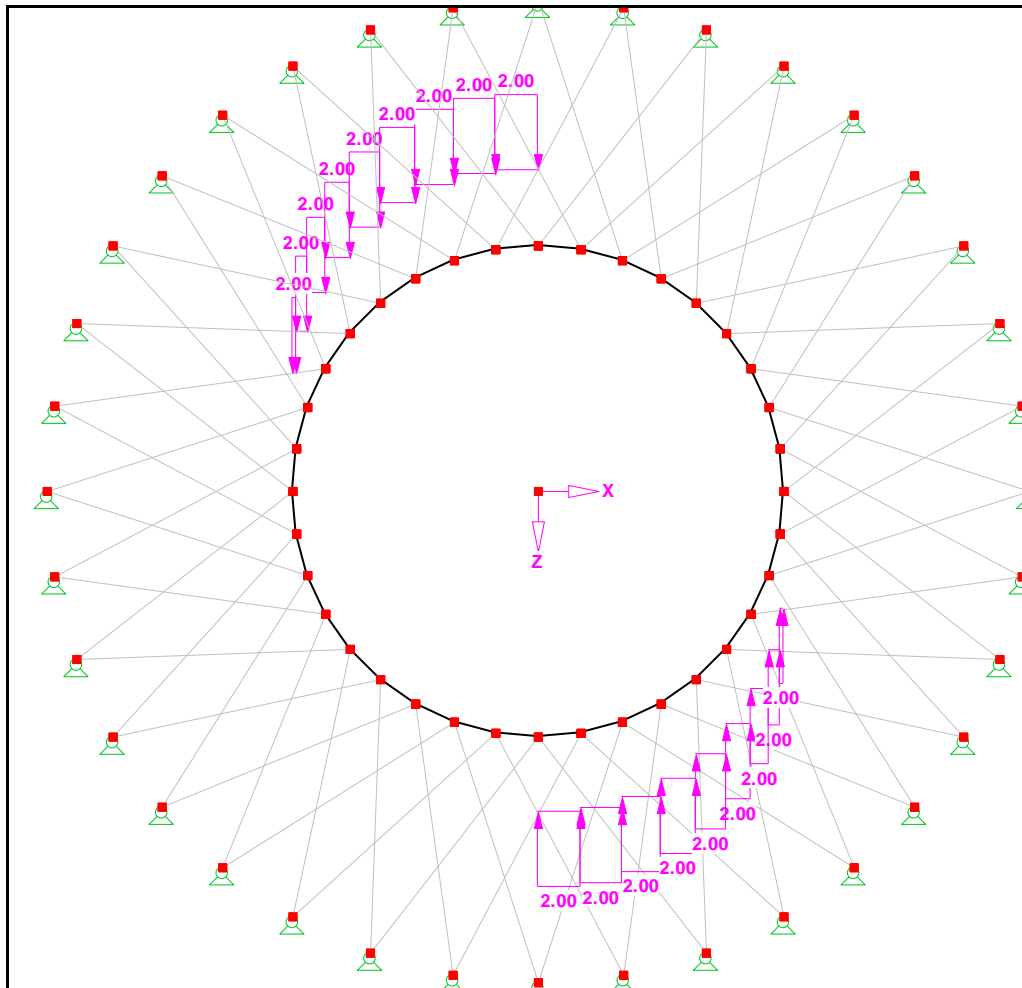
Modell mit je 2 Stabfedern pro Bettungslager [RSTAB]
